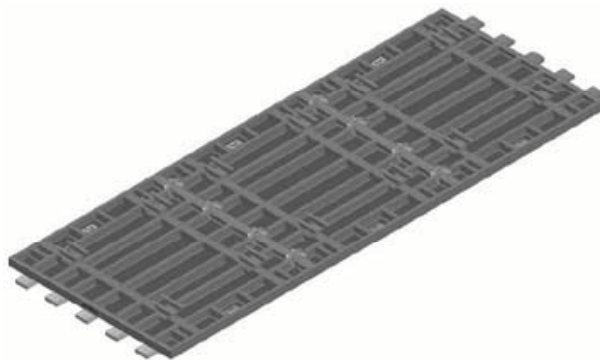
Encofrado de pilares. Fuente: encofrados.org
